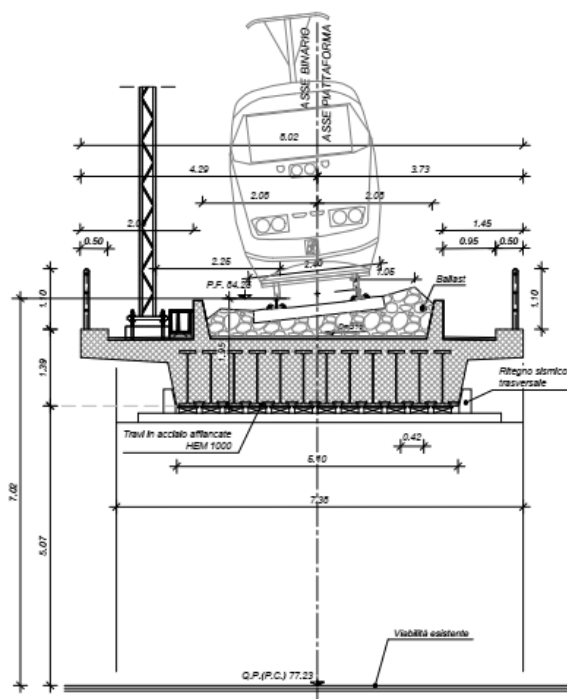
Sottovia SL01 – Sezione trasversale impalcato
